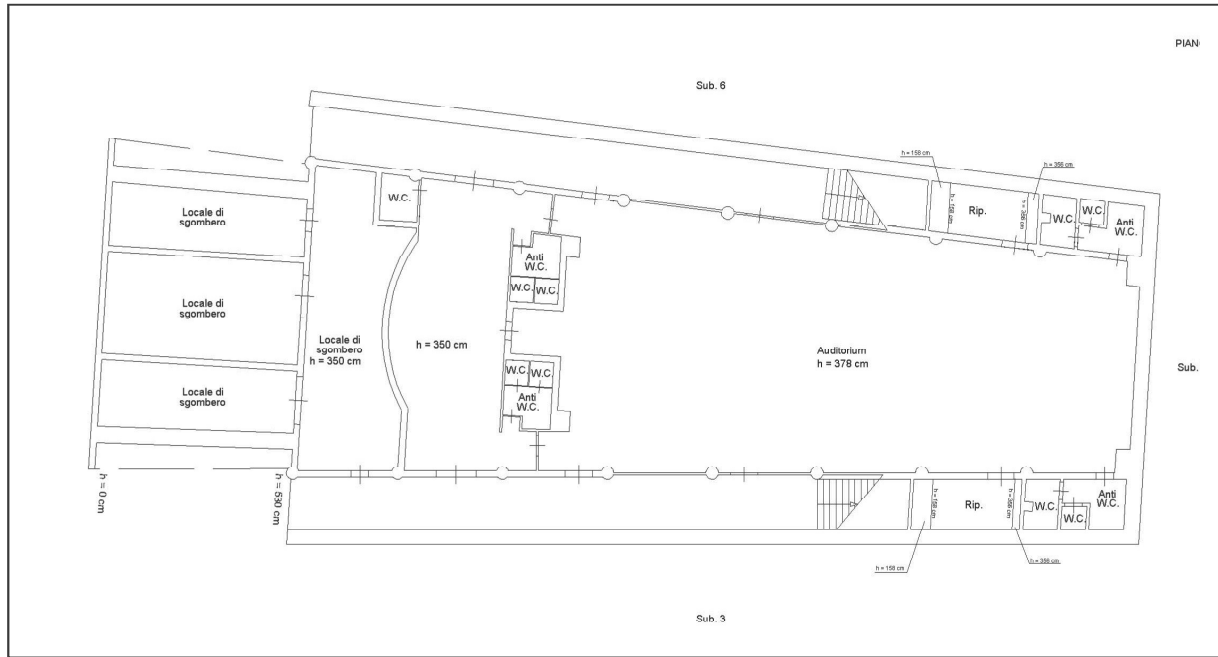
Auditorium identificato al sub. 11. Planimetria catastale
